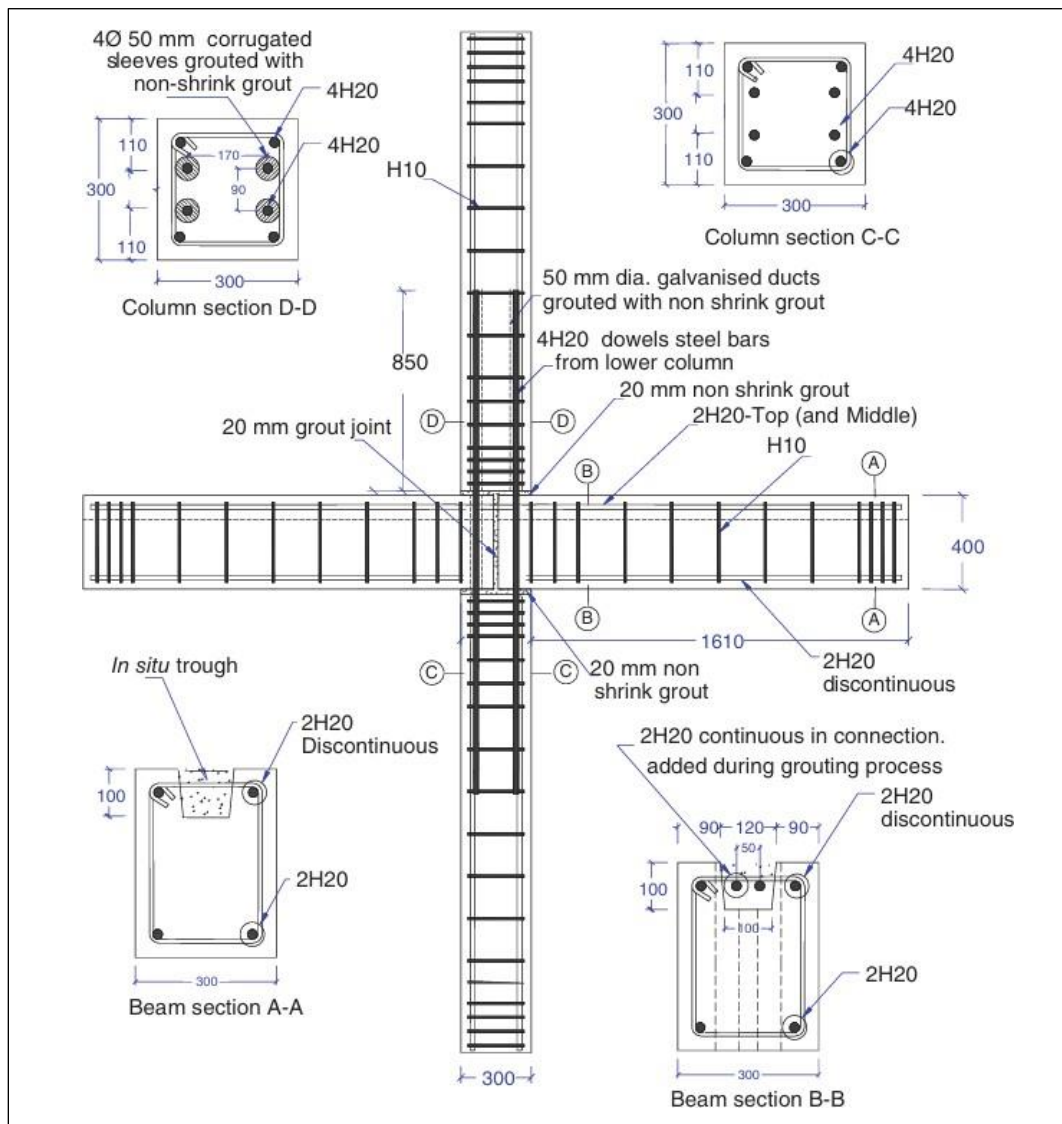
Conception d'une connexion poutre-poteau en béton préfabriqué avec éléments de poutre et de poteau discontinus [36].
